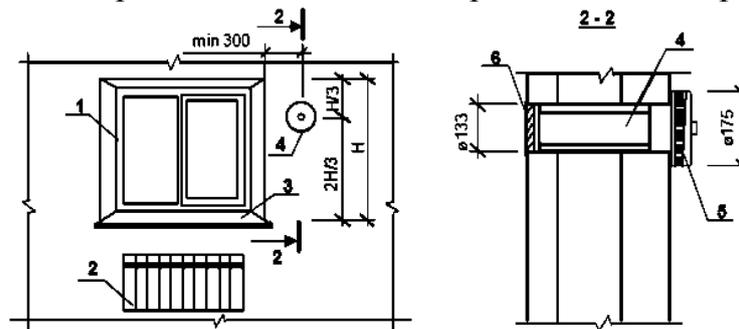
Схема монтажа стенового приточного вентиляционного клапана КИВ-125: 1- оконный блок, 2 - прибор отопления, 3 – подоконник, 4 – стеновой приточный клапан КИВ-125, 5 – оголовок приточного клапана, 6 – наружная решетка клапана
